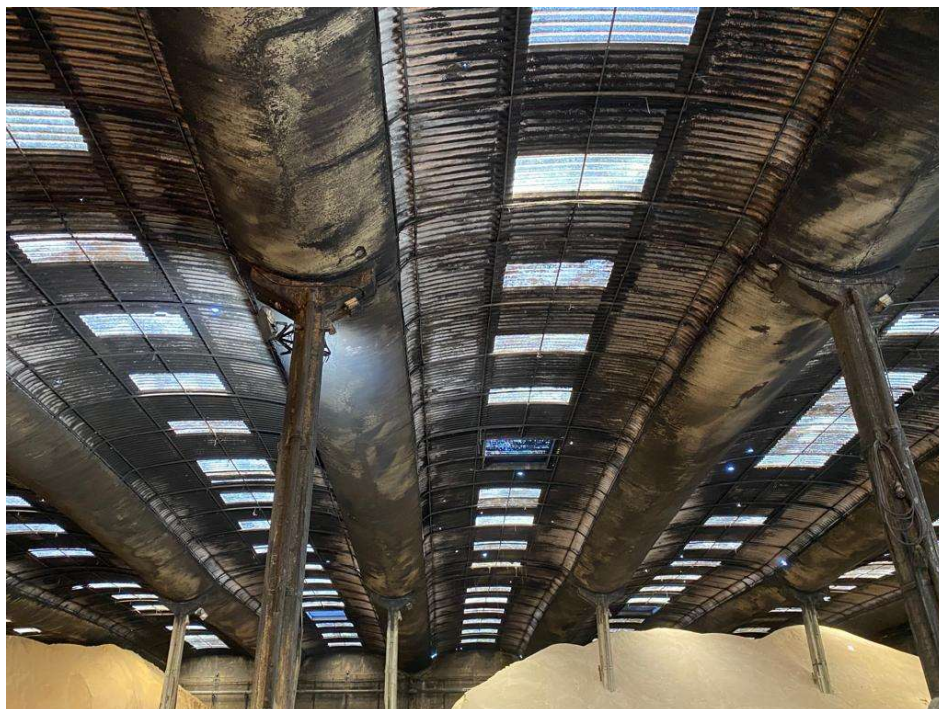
Vista inferior 1 do telhado de fibrocimento
